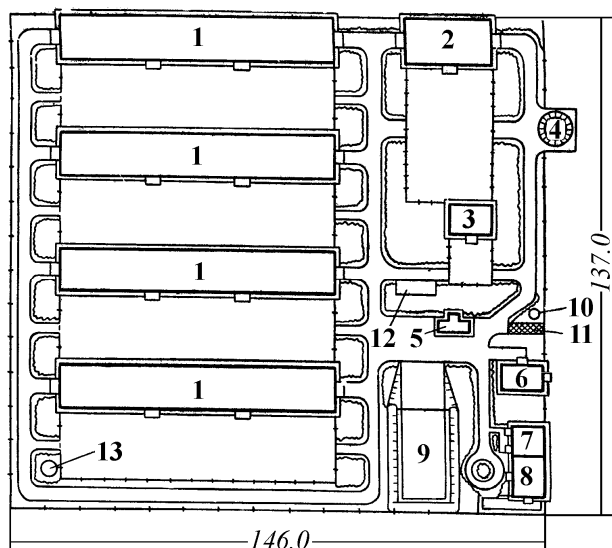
Генеральный план фермы на 2500 пуховых коз:
